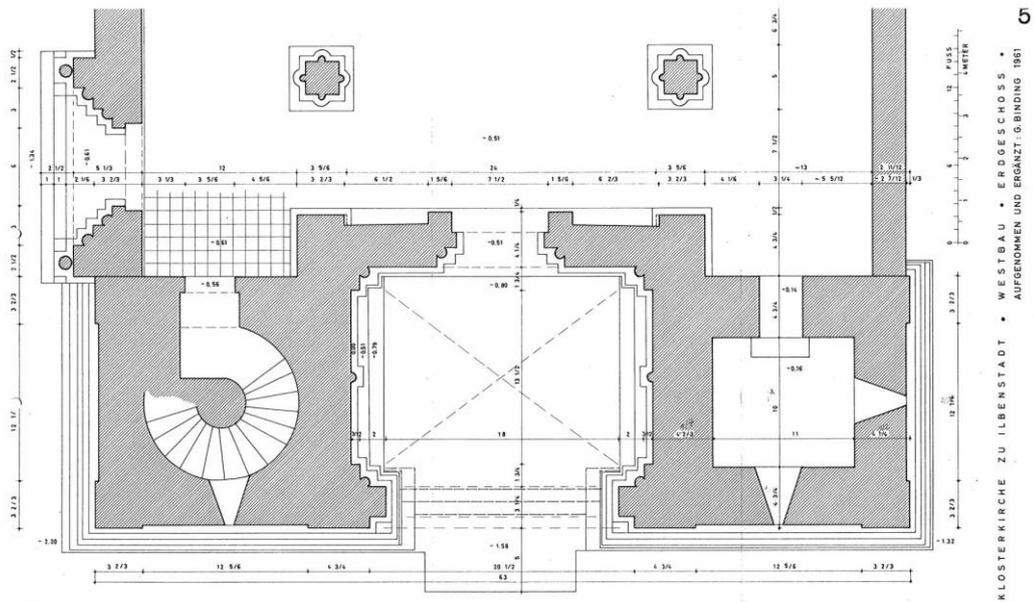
Grundriss der Basilika in Ilbenstadt aus der Restaurierungskampagne 1961-69.
